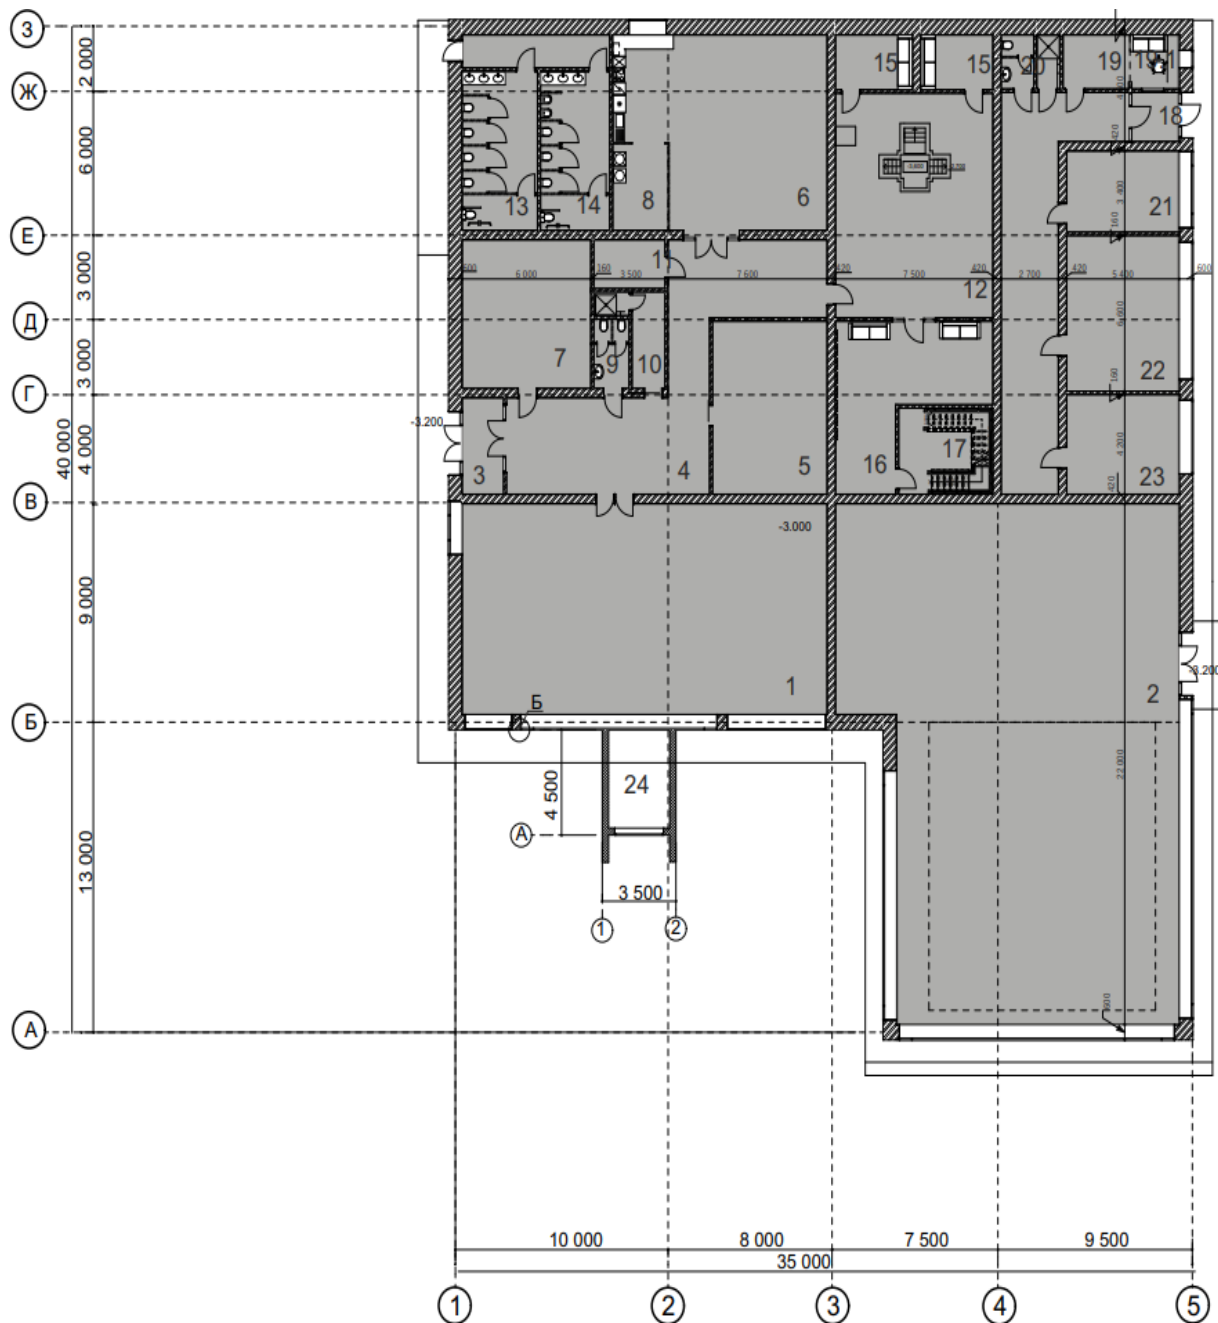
План цокольного этажа: 1 – конференц-зал; 2 – зимний сад; 3 – тамбур; 4 – коридор; 5 – служебная; 6 – трапезная; 7 – гардероб; 8 – кухня; 9 – санузел служебный; 10 – уборная; 11 – венткамера; 12 – крещальня; 13 – санузел мужской; 14 – санузел женский; 15 – раздевалка; 16 – приходской гардероб; 17 – лестница; 18 – тамбур школы; 19 – гардероб; 19.1 – охрана; 20 – санузел школы; 21 – кабинет 1; 22 – кабинет 2; 23 – кабинет 3; 24 – колокольня
